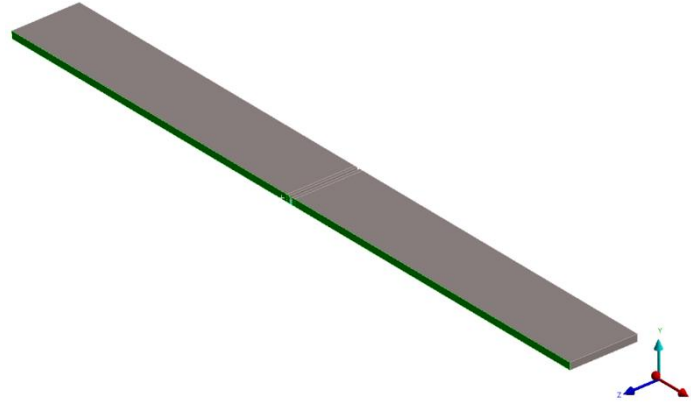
Application de la condition de symétrie sur un côté des dalles de faux plafond (dalles discontinues)
